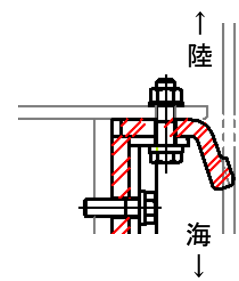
防波扉戸当り (RC 支柱) の概略配筋図 (B-B 断面)
